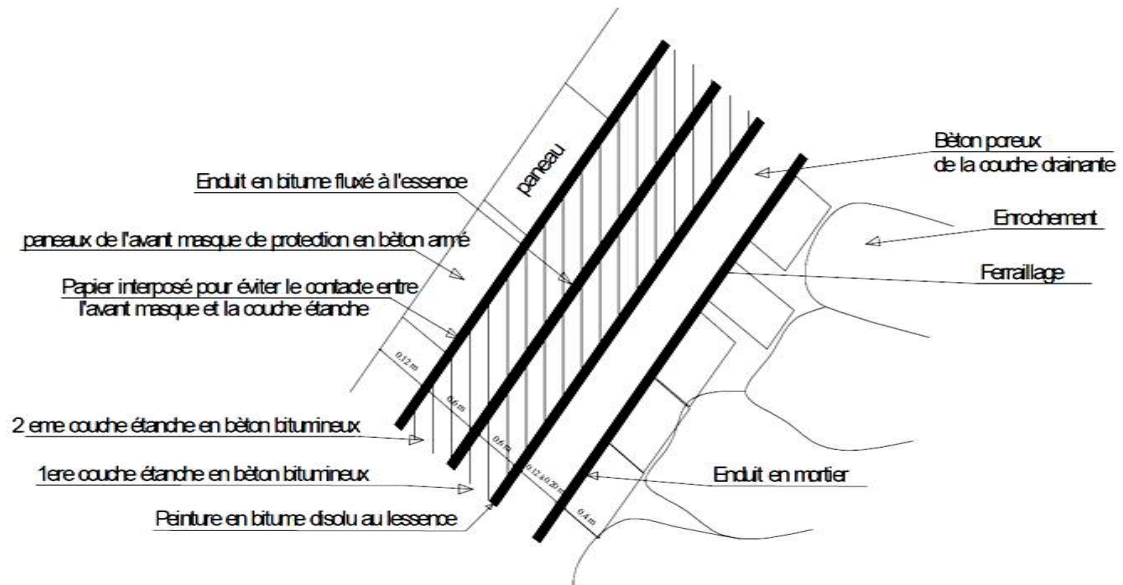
Coupe du masque en béton bitumineux de barrage de Bouhnifia (Bounaadja, 2009).
